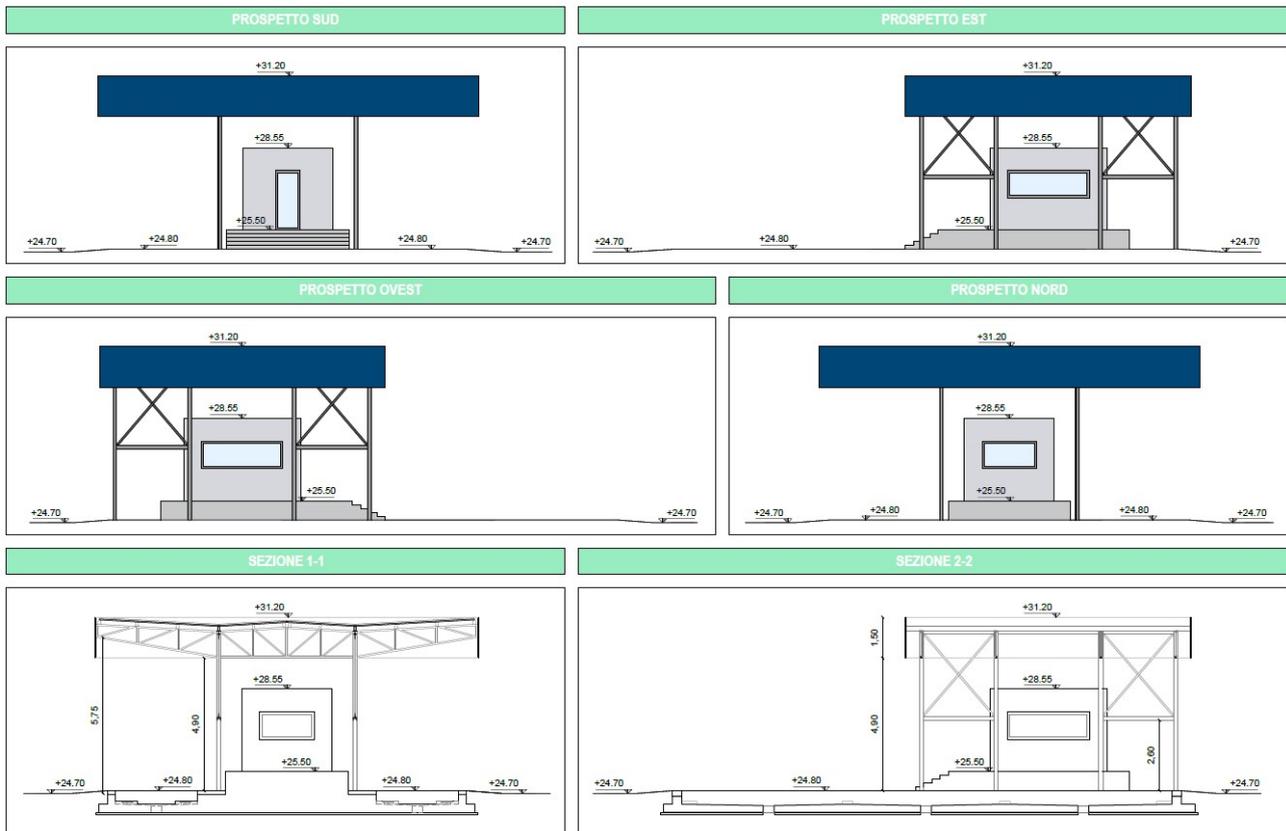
Prospetti e sezioni della nuova area di pesatura
